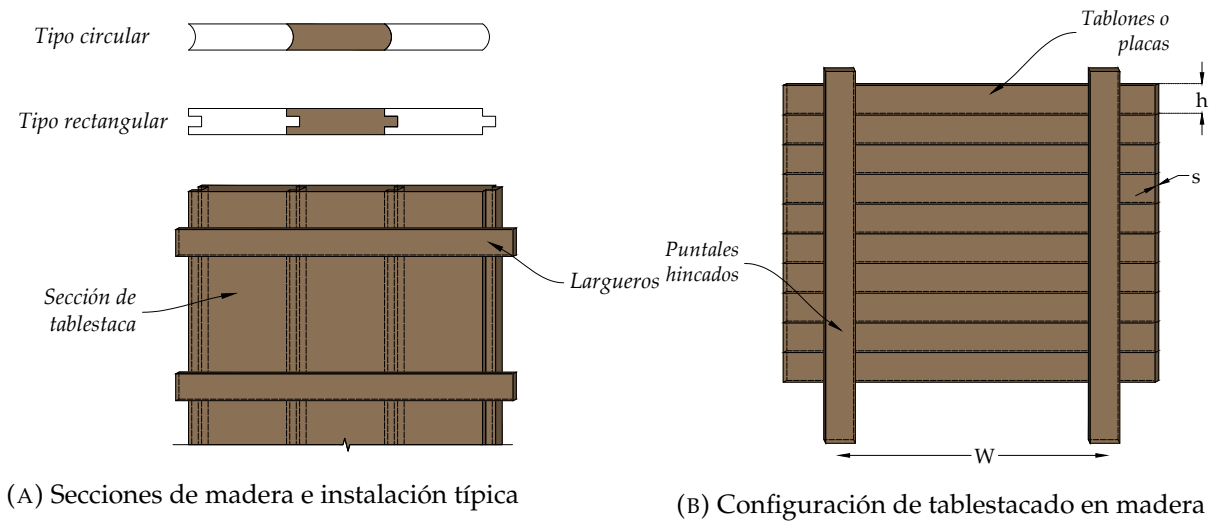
Sección transversal típica para tablestacas de madera
